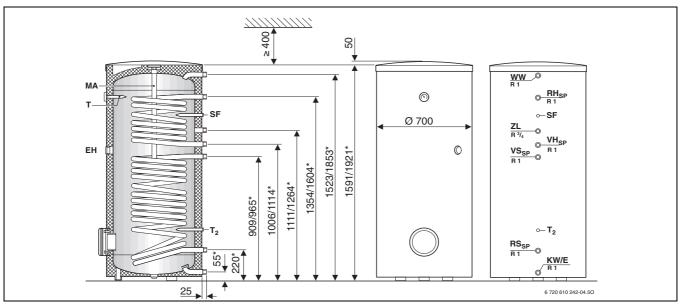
Bau - und Anschlussmaße SK 400/500-1 solar
